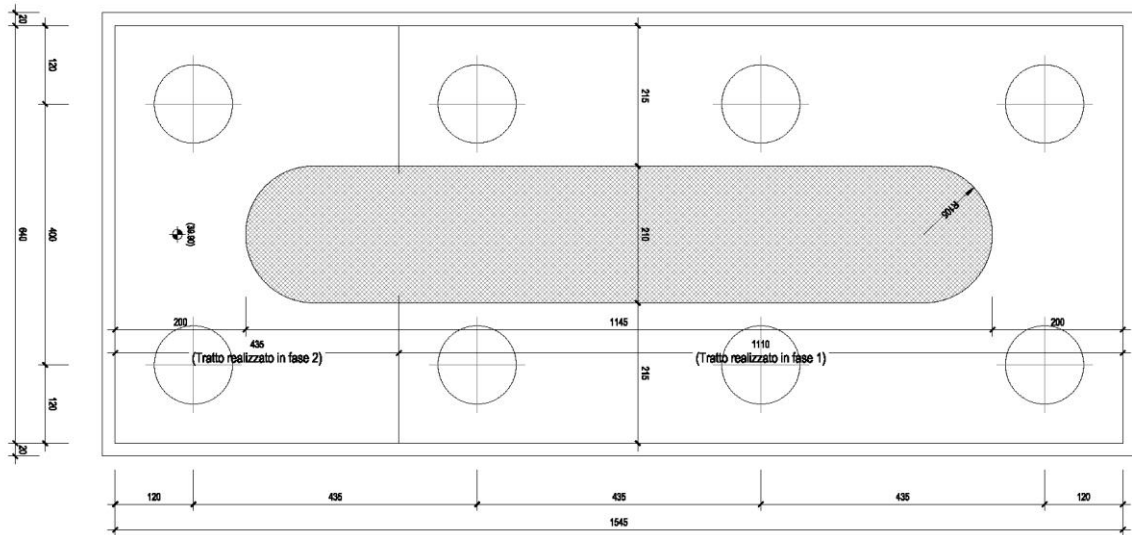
Plinto di fondazione e pali, vista in pianta - Sezione del fusto pila [m]
